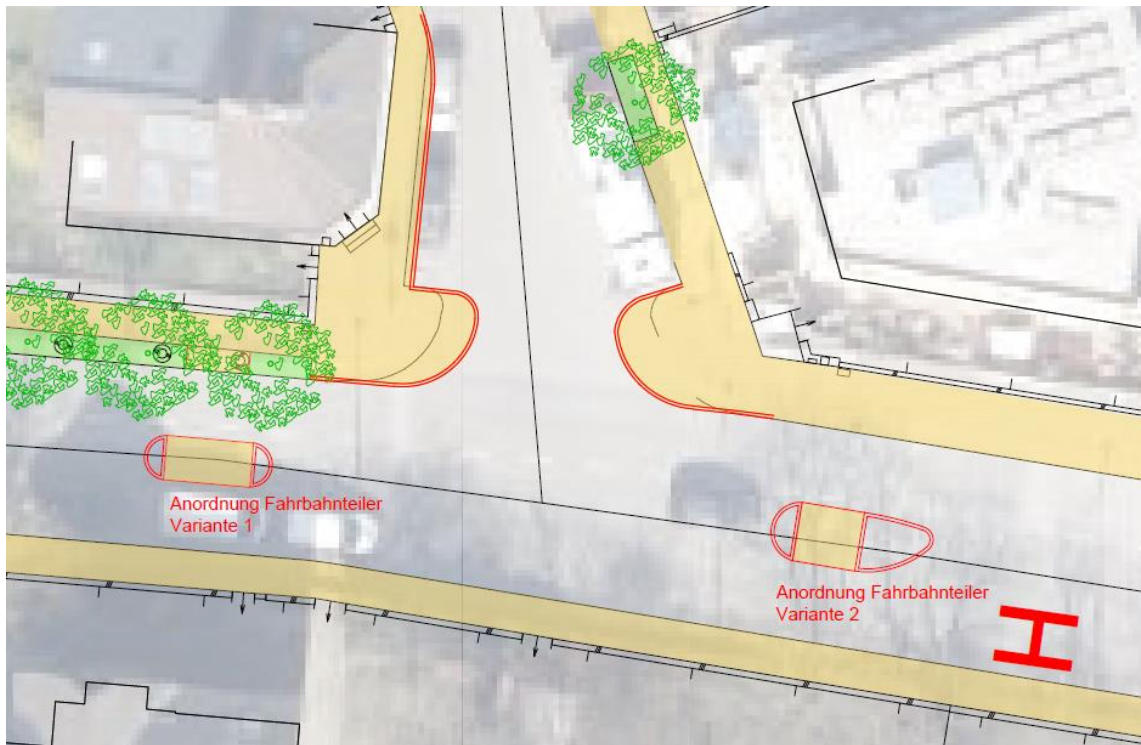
Ausschnitt Planungsvariante 1 & 2 Friedrich Schiller-Straße # Eisentorgasse
